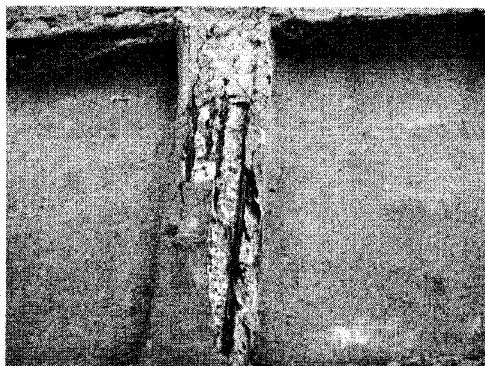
Корозія арматури і руйнування бетону вертикальних ребер збірних плит оболонки градирні № 4 на Дарницькій ТЕЦ, захисний шар бетону нижче від проектного
